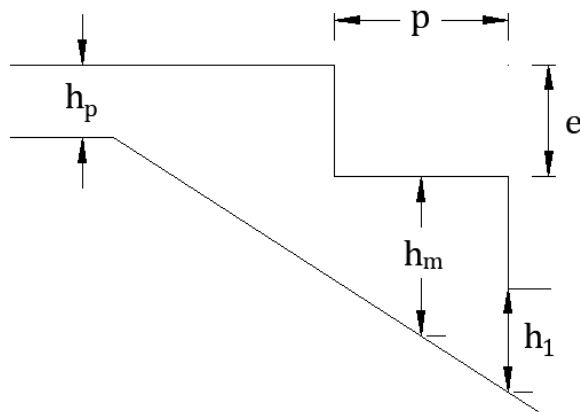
Corte longitudinal da escada, especificando a espessura média dos degraus (Fonte: autor).
